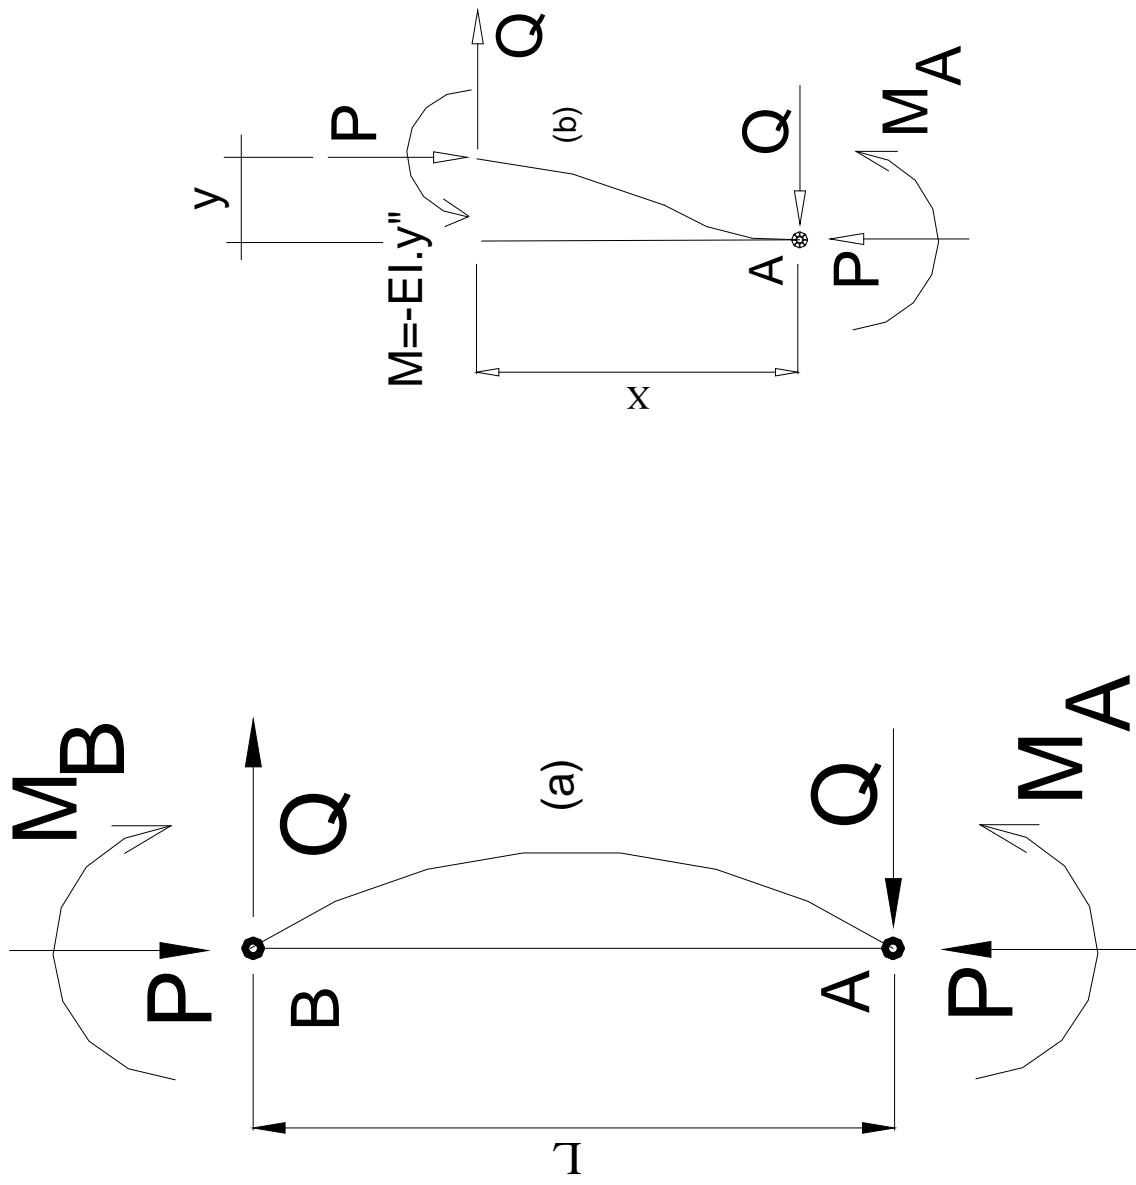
POTEAU SOLLICITE EN COMPRESSION FLEXION
